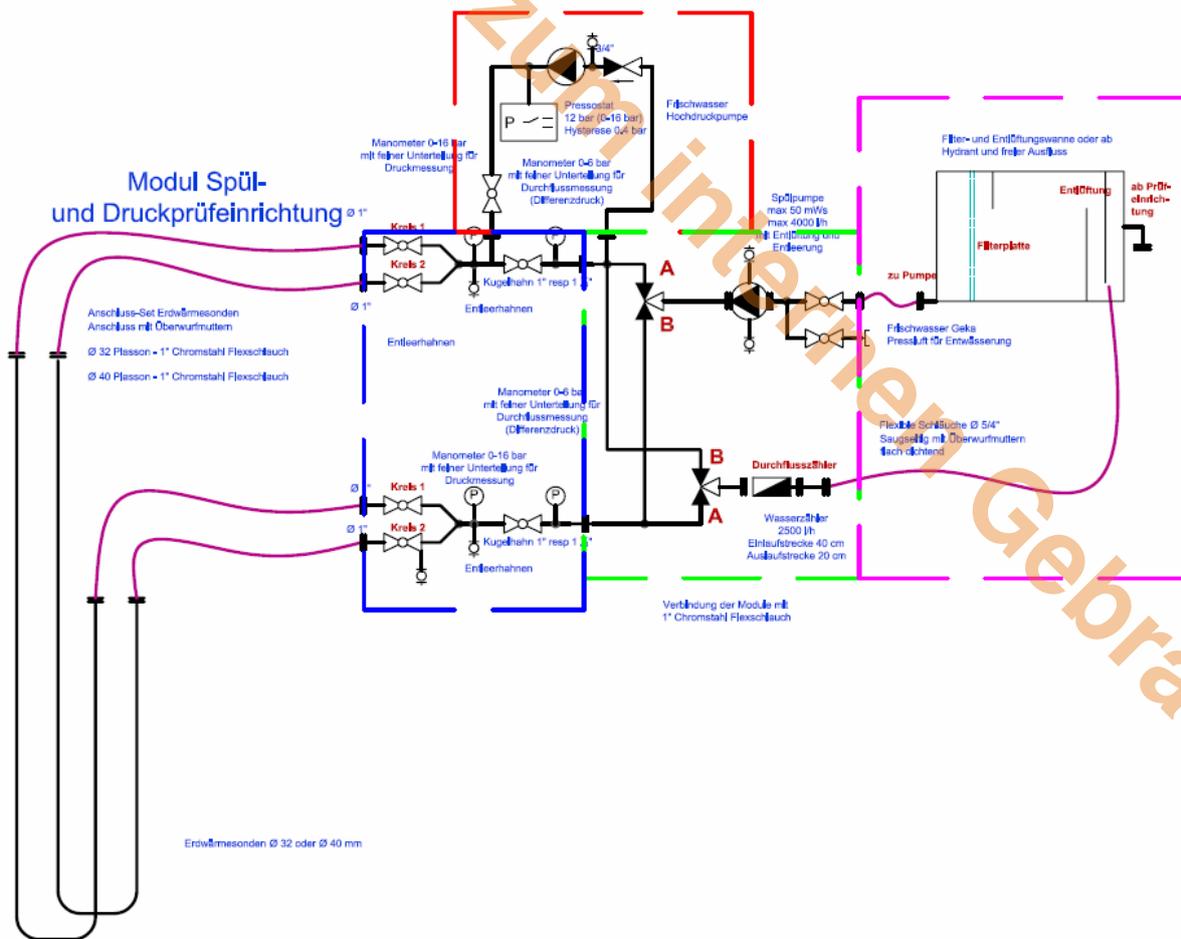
Schema einfache Druckprüfeinrichtung mit Spüleinrichtung.
